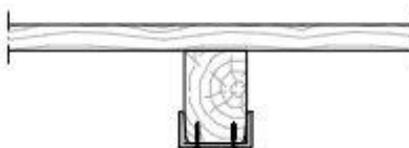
Reforço de viga através da colocação de perfil UNP na face inferior, conectado mecanicamente com ligadores metálicos (Brites, 2011)
